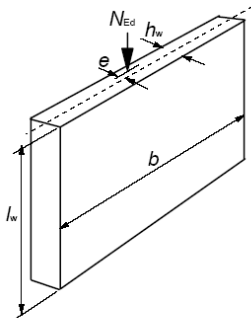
Bezeichnungen für unbewehrte Wände
